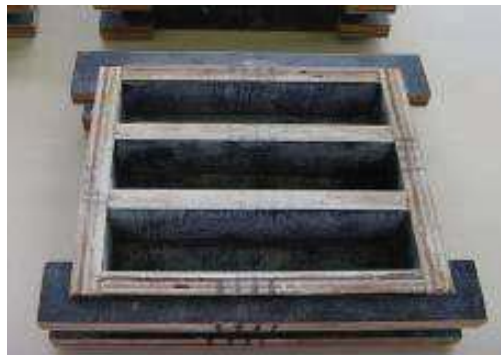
Formas prismáticas para moldagem dos corpos-de-prova
